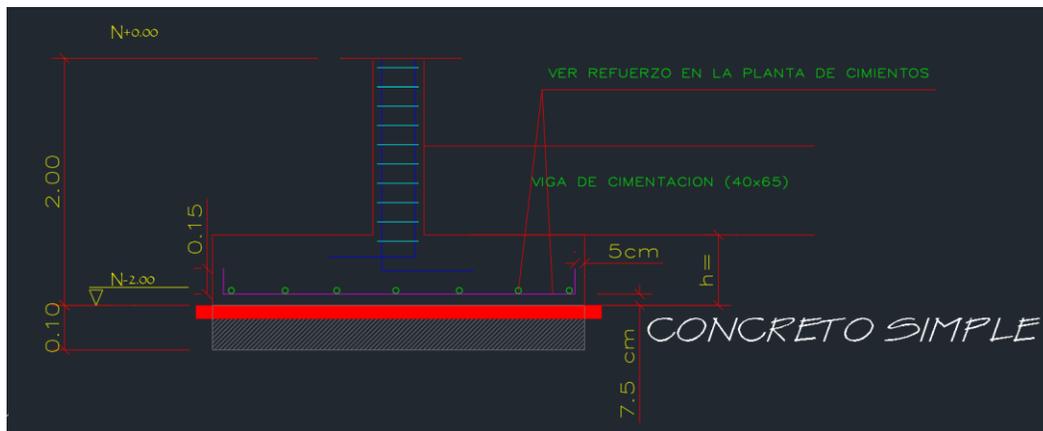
despiece zapatas aisladas (fuente: planos estructurales Edificio Fourvière)
